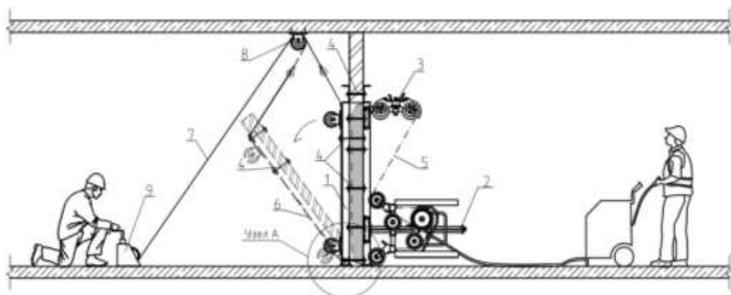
Вид сбоку при вертикальном резе проема несущей железобетонной или каменной стены
